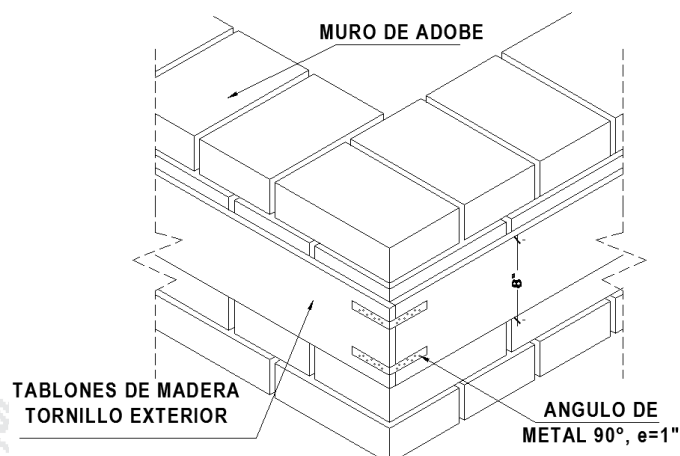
Detalle exterior de viga collar (Kuroiwa, 2004).
